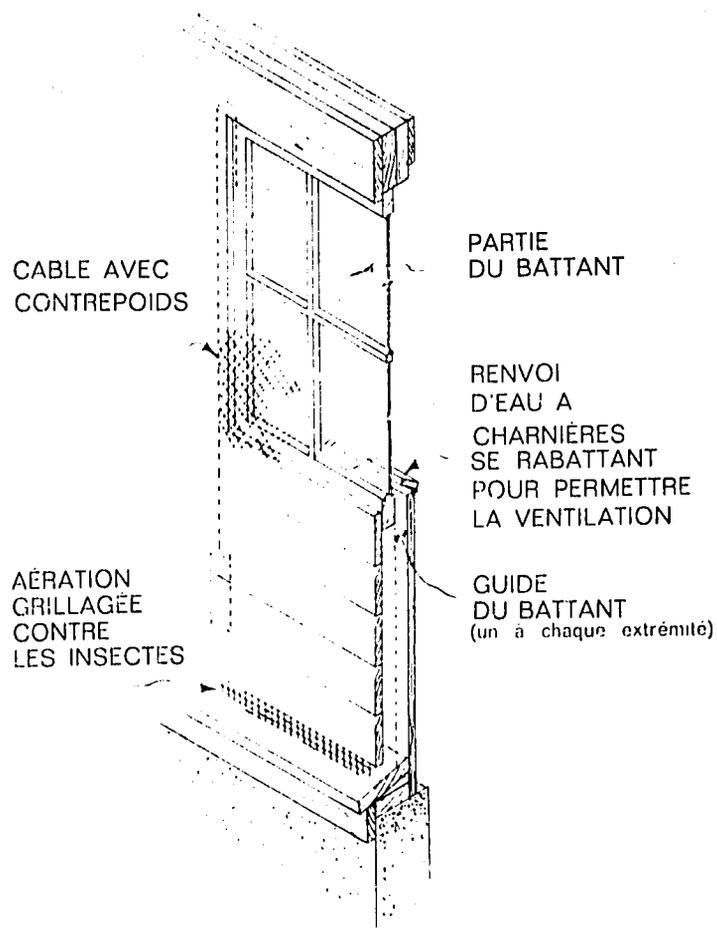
Fenêtre coulissant verticalement à l'intérieur du mur caisson.
